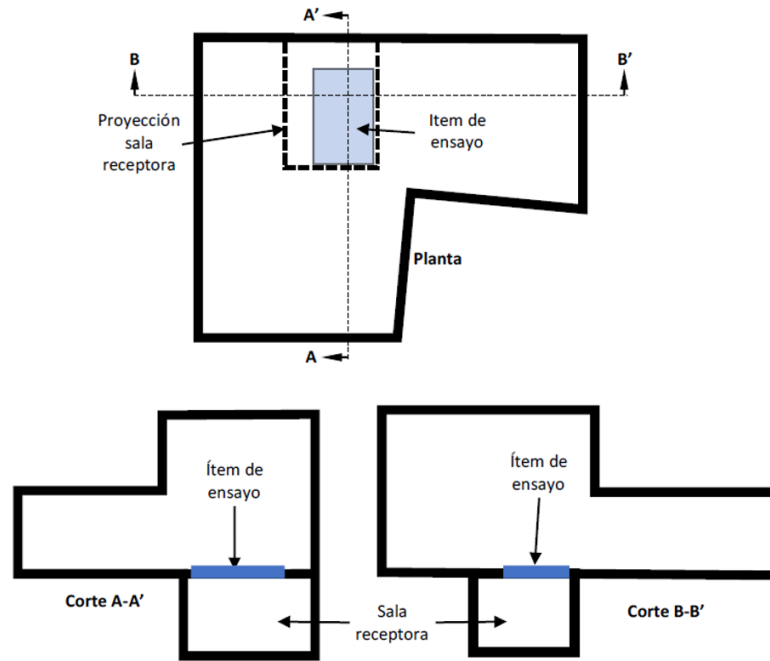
Esquema de planta y corte de los recintos de ensayo
